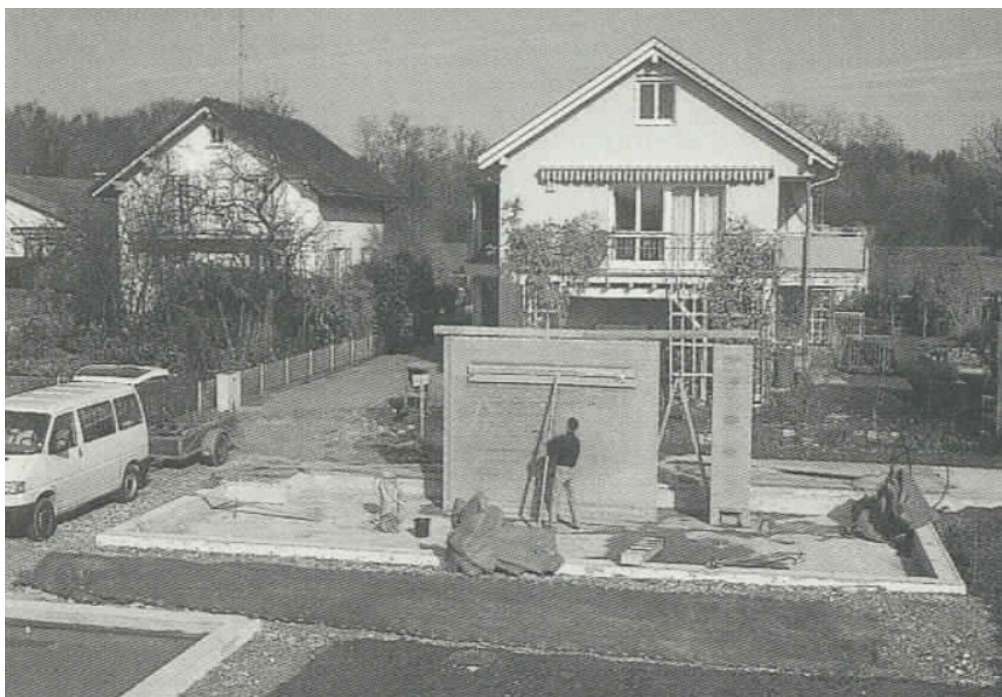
Construcción "in situ" del muro en tapial sobre la losa de H.A.
